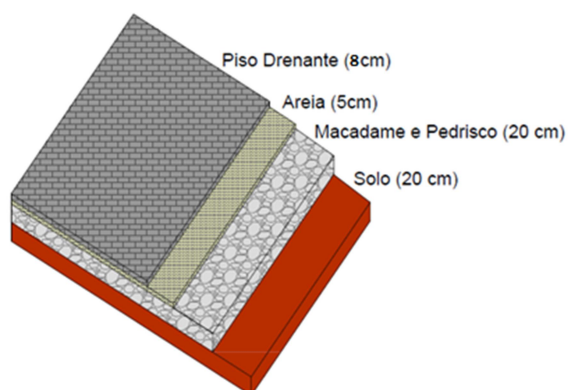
Esquematização das camadas da estrutura do piso drenante no primeiro e segundo ensaio.
